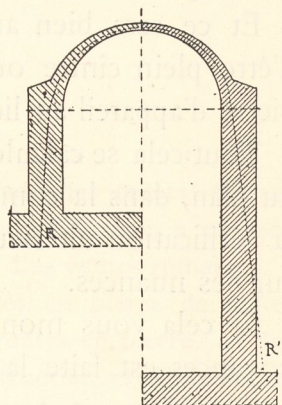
Stabilité et instabilité d'une même voûte, suivant la hauteur des piedsroits.
